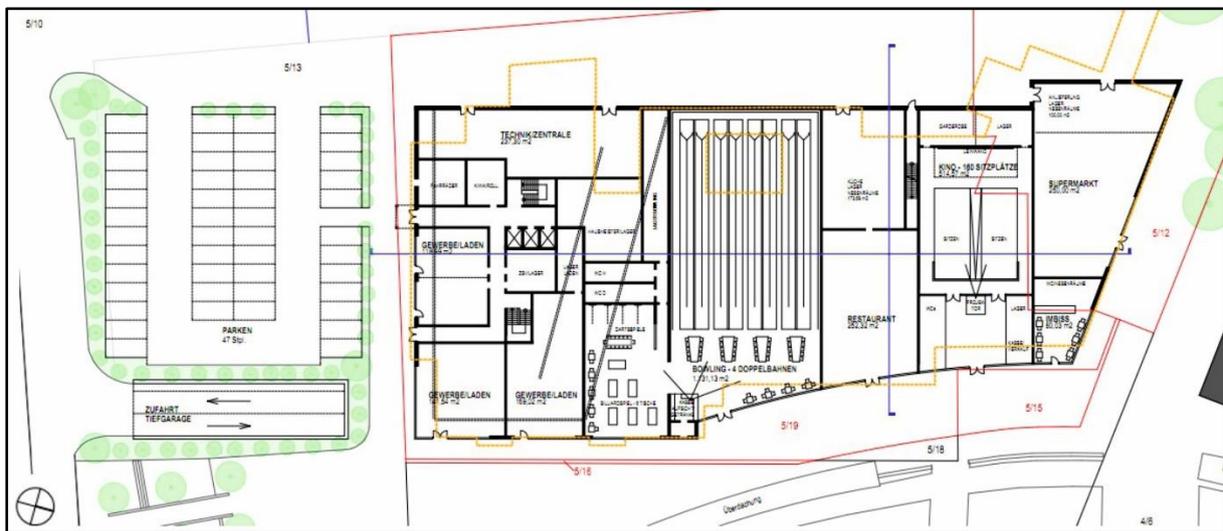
Objektplanung, Darstellung des Erdgeschosses (Architekturbüro Gollus, Stand: 21.06.2019)
